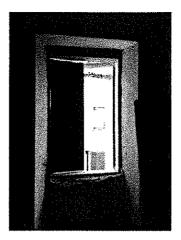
Pavimento vano 2 Foto 23: Finestra mancante
